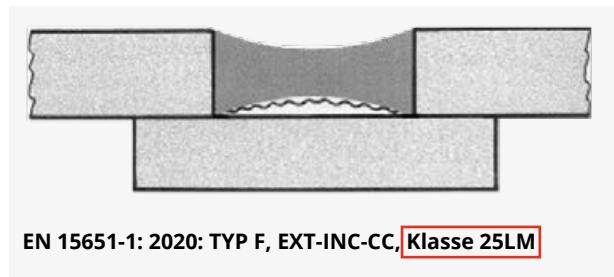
Fachgerechte 2-Flanken-Haftung
